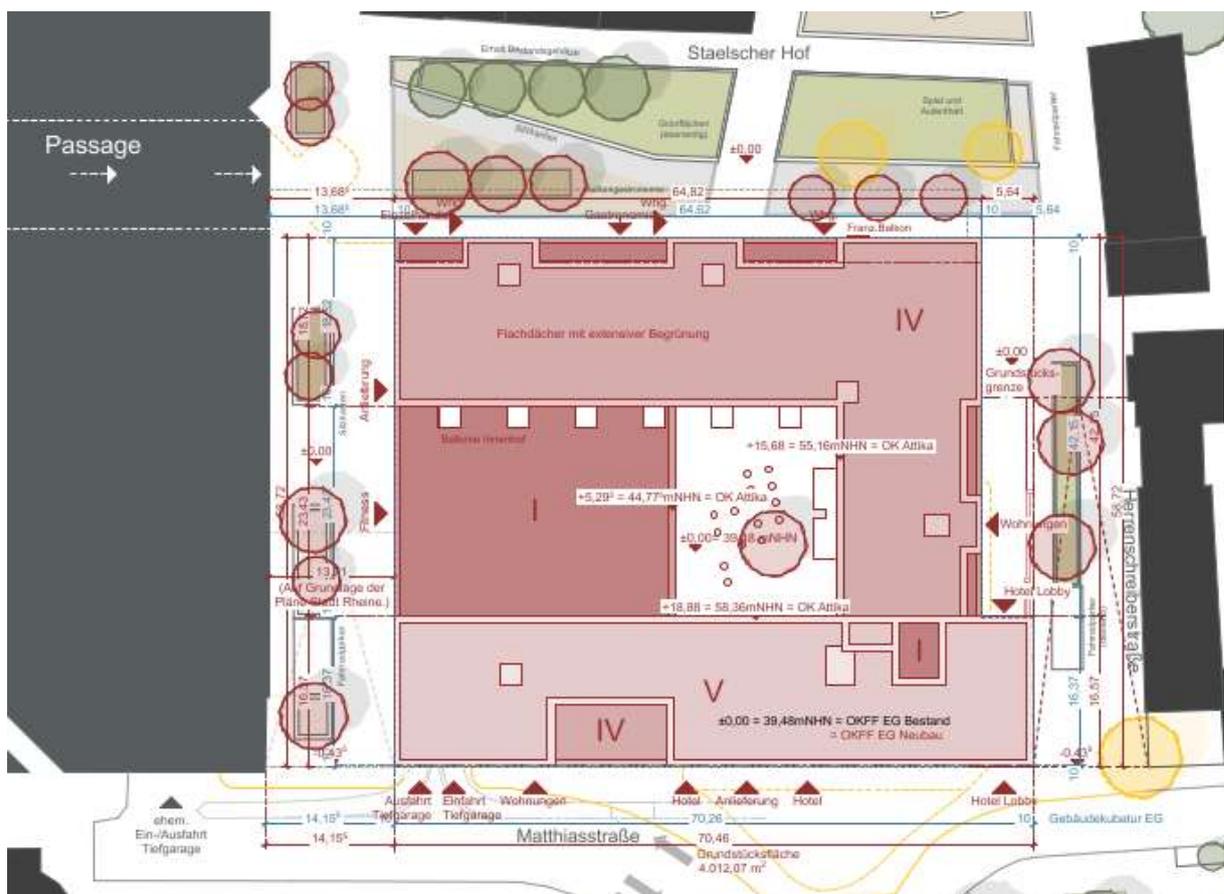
Lageplan, Achterkamp + Möller Architekten, 2022
